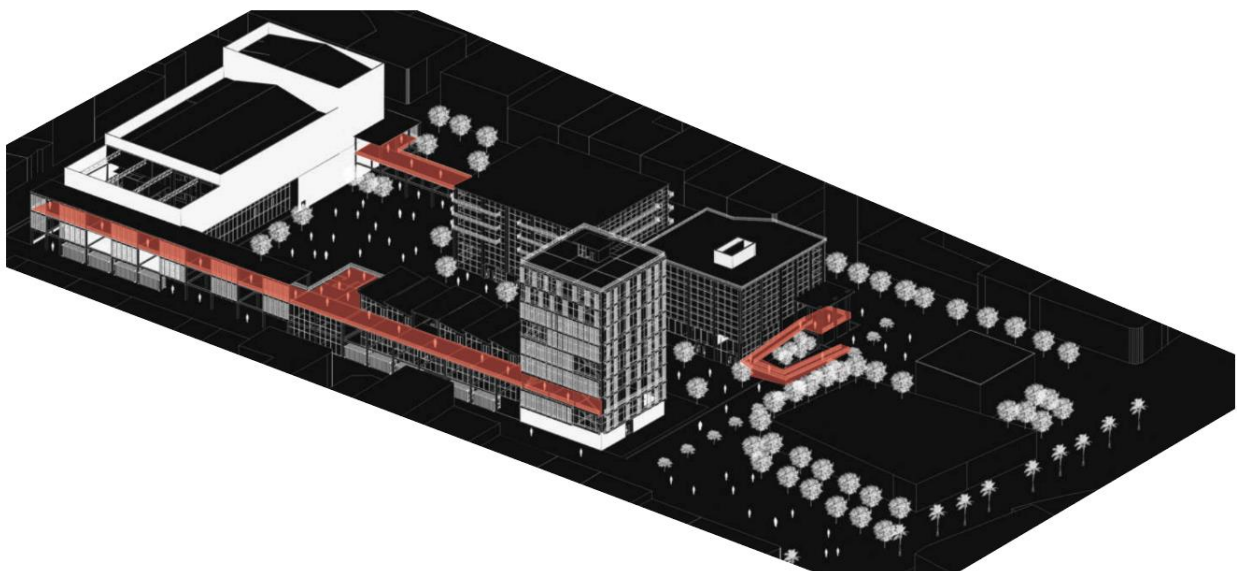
Vista General del Proyecto. Fuente: Elaboración Propia
